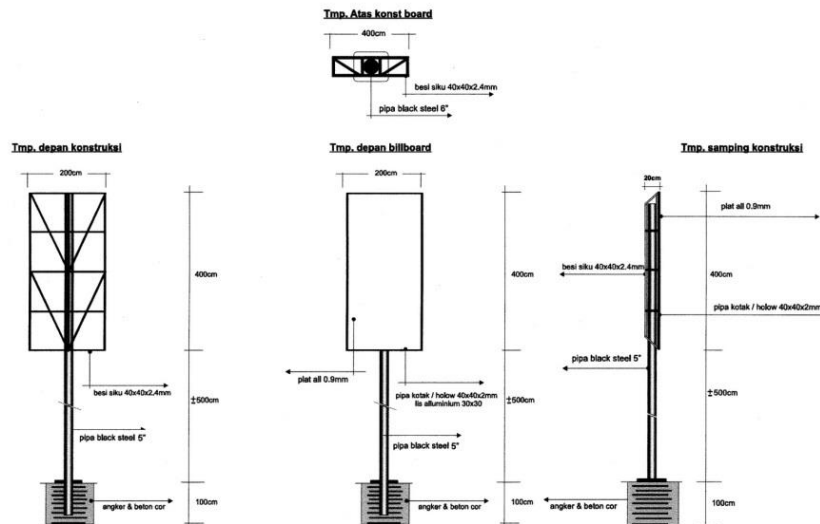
2 Konstruksi Papan Billboard/Baliho Vertikal
